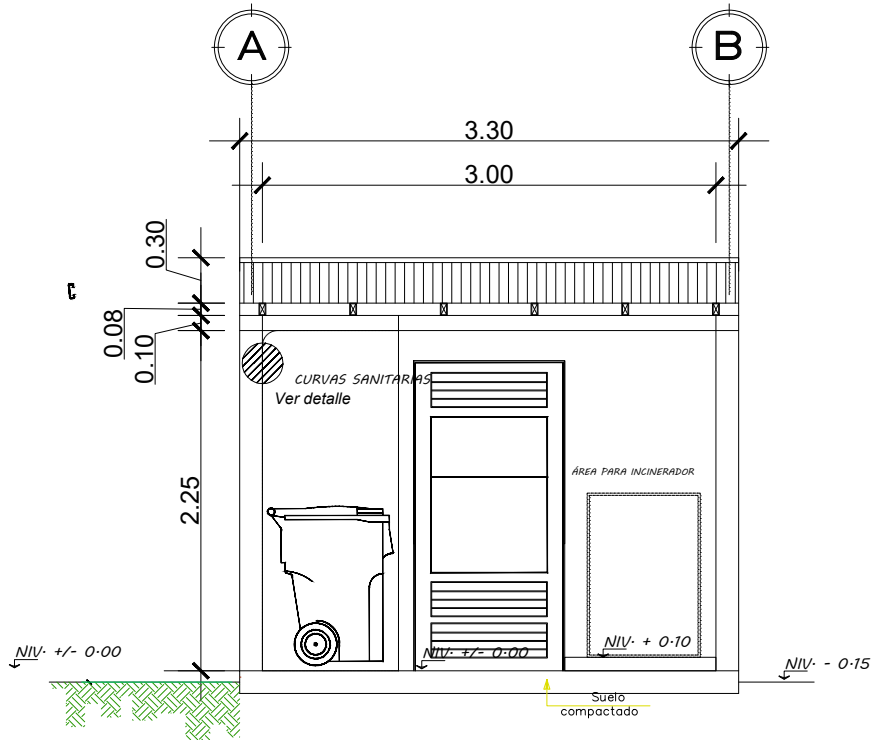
Sección longitudinal del centro de acopio propuesto | Crédito: equipo consultor.
